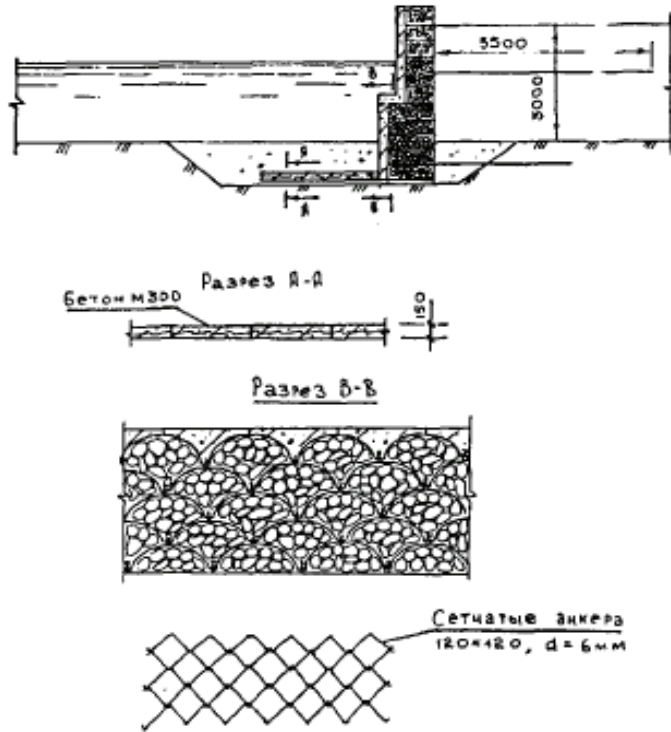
Габрионная подпорная стенка с бетонной облицовкой и сетчатыми анкерами (вариант 5)
